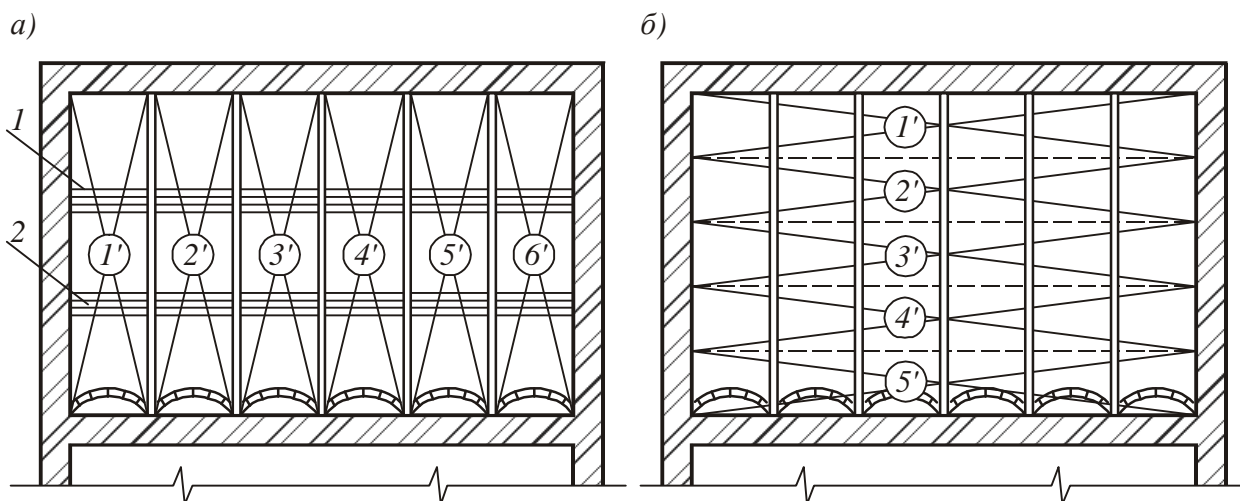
Разборка кирпичных или бетонных сводов по металлическим балкам: *а* – продольная схема; *б* – поперечная схема; *1* – борозды в сводах; *2* – распорки из бревен; *1'...6'* – последовательность разборки
